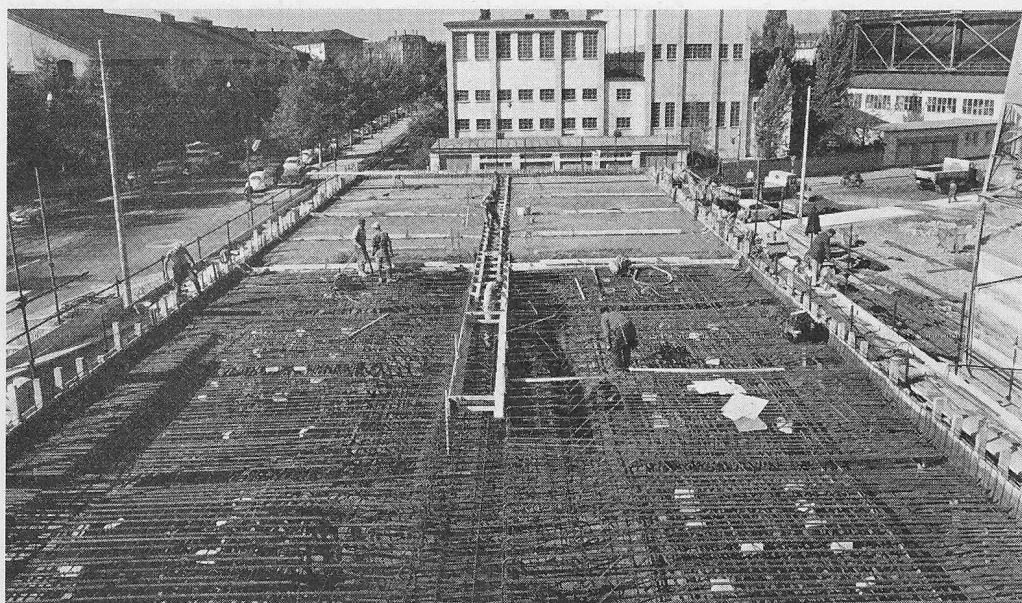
Verwaltungsgebäude Durand & Huguenin. Decke über Erdgeschoss während des Betonierens
